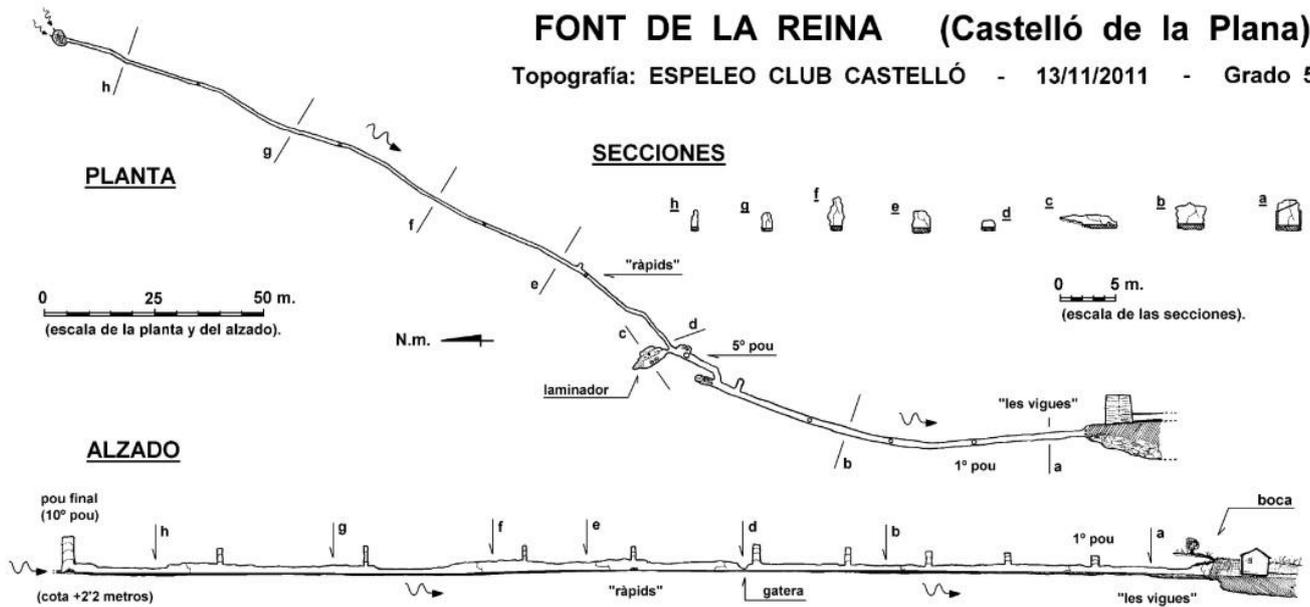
Croquis en planta y alzado de la galería del Molí de la Font (de Joaquín Arenós Domínguez – Espeleo Club Castellón)
